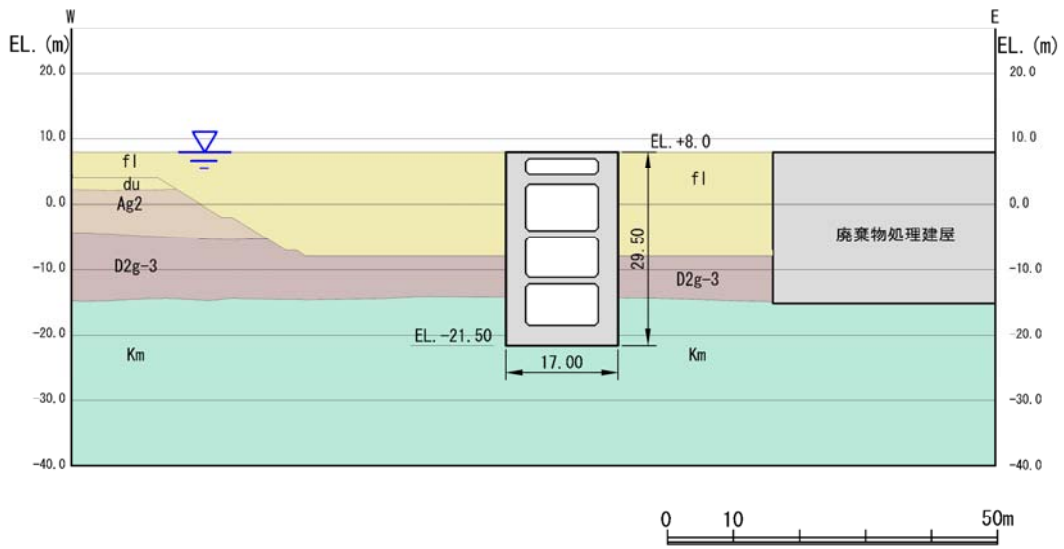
(1) 常設低圧代替注水系ポンプ室断面図 (東西方向断面)
